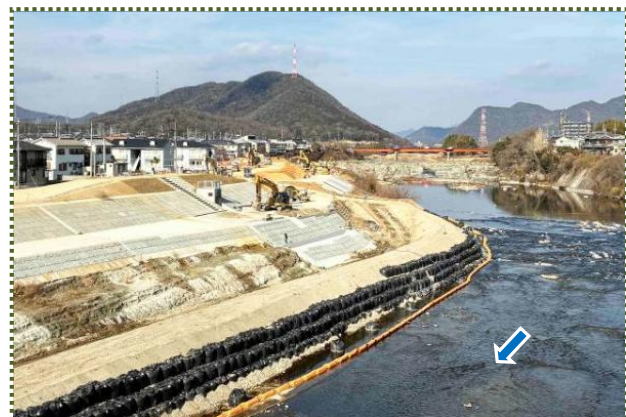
滝見橋から右岸の護岸工施工状況を撮影
